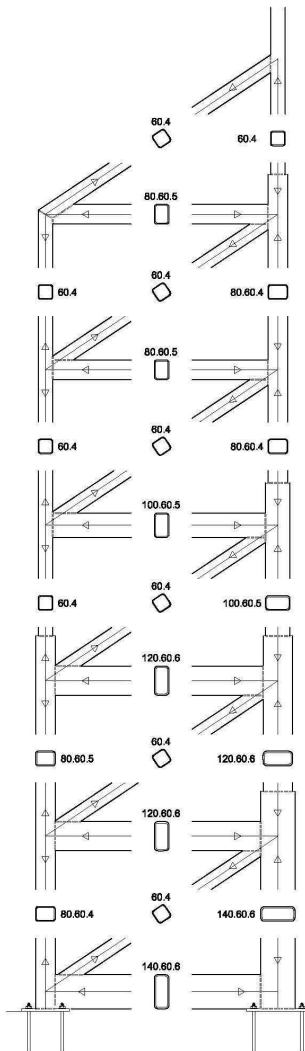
Detalle de ensamblaje de la estructura de estabilización
